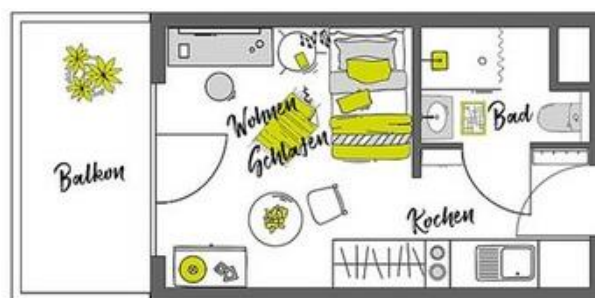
Beispielgrundriss eines Mikroapartments (vgl. i Live GmbH 2023)
